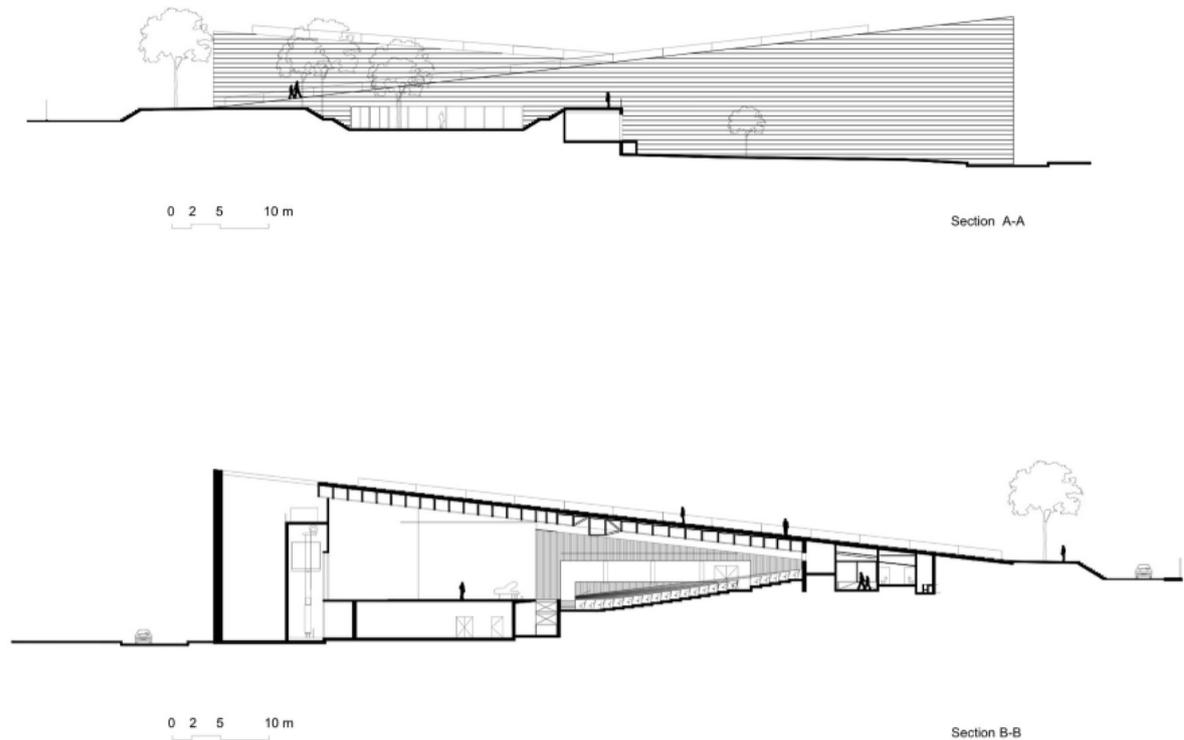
Cortes longitudinais. Fonte: ARCHDAILY, 2018.
